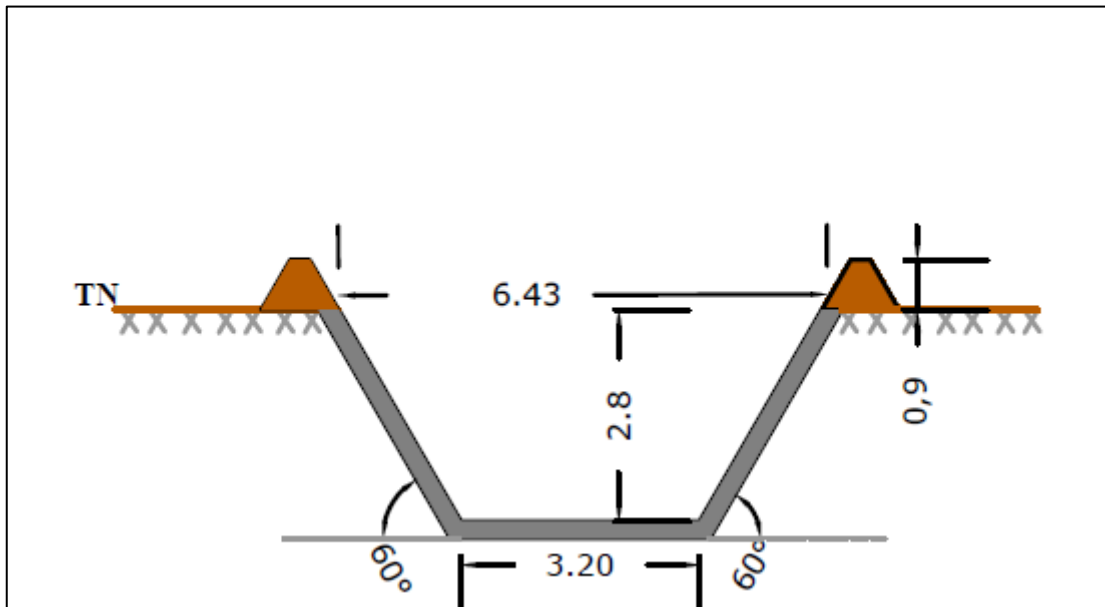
Schéma d'un aménagement en béton armé (section trapézoïdale).
